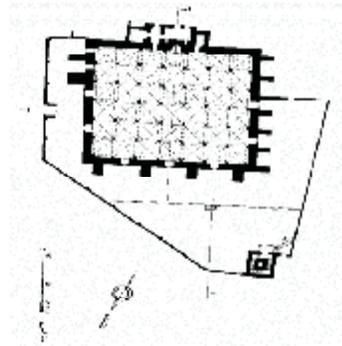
مسقط أفقي لجامع القرويين بفاس القديمة
